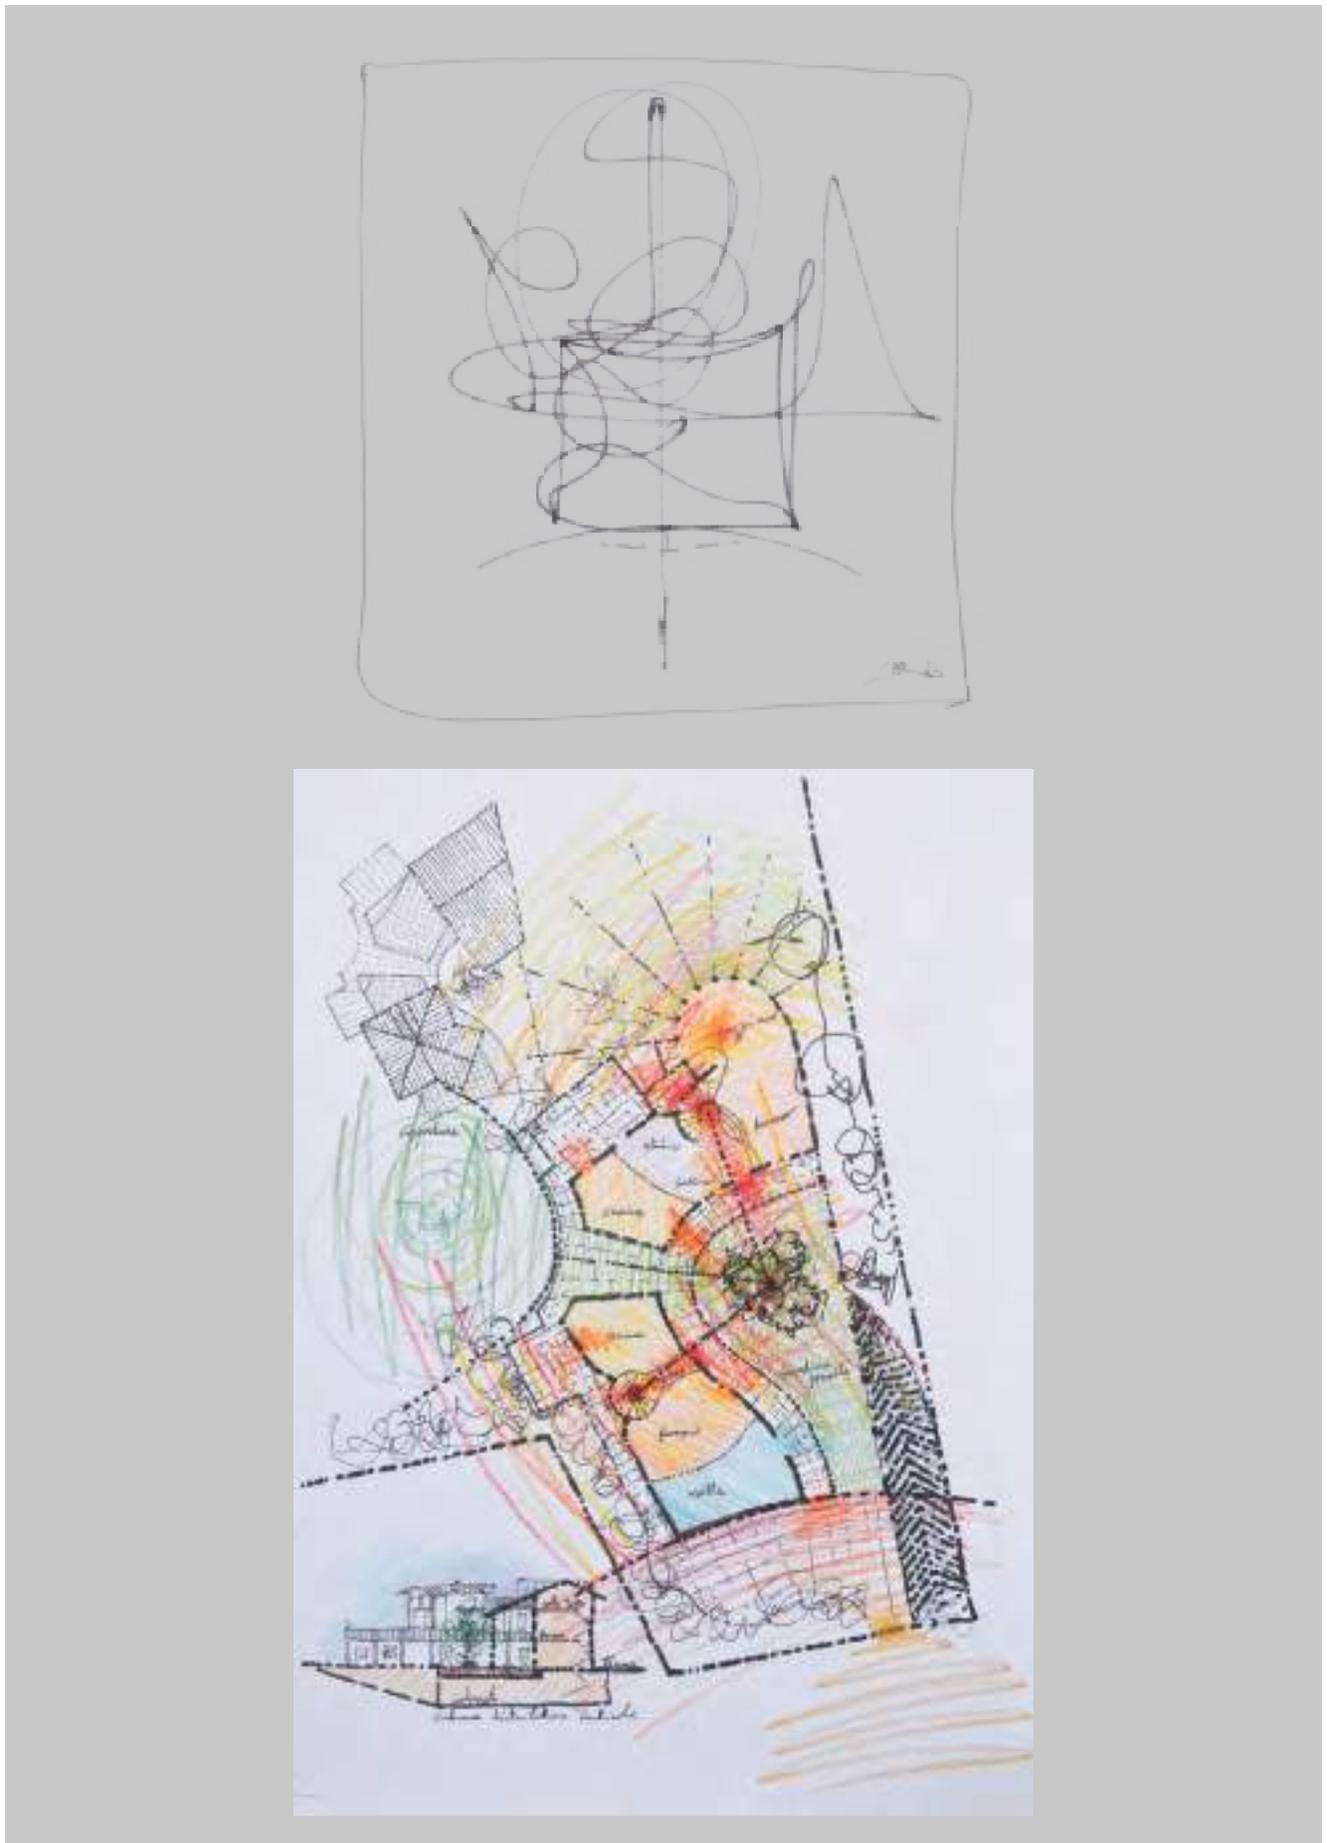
Schizzi per un alloggio a Bardonecchia, su planimetria di cantiere, 2007.
